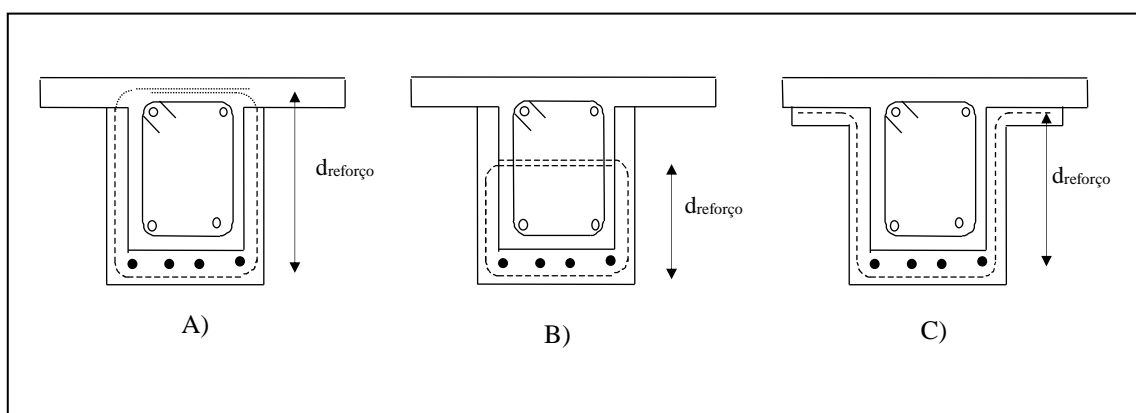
Disposições de armaduras mais utilizadas no encamisamento de vigas.
